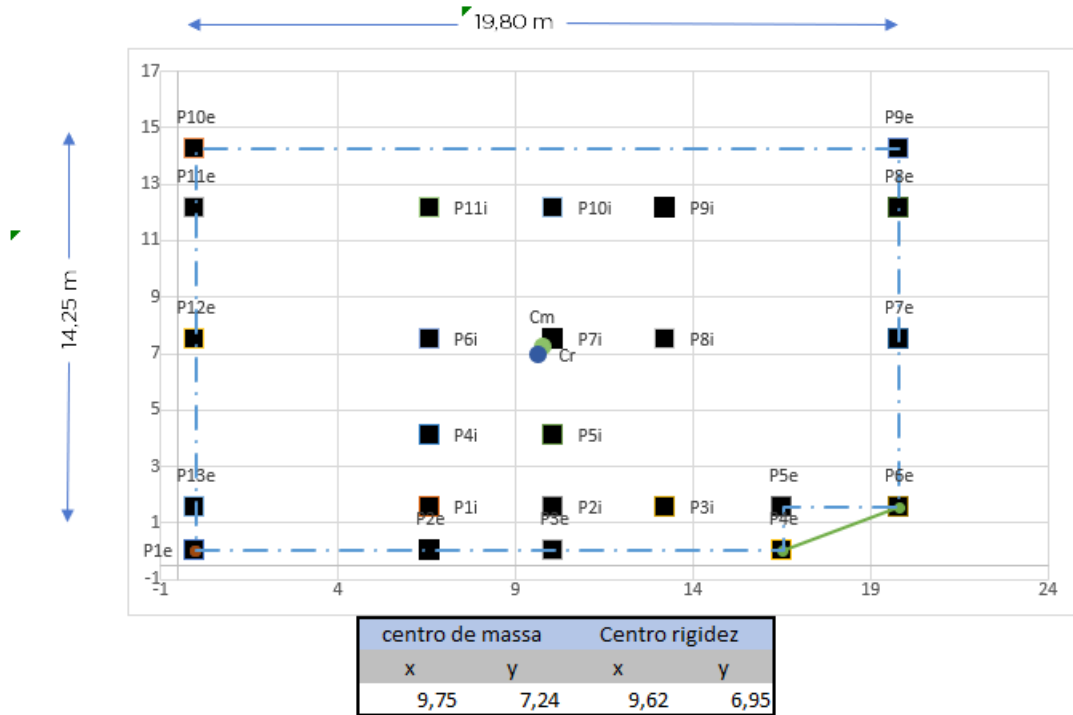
Representação esquemática da planta inserida, com os valores do centro de massa e rigidez (área em planta a tracejado azul; linha poligonal convexa a verde)
